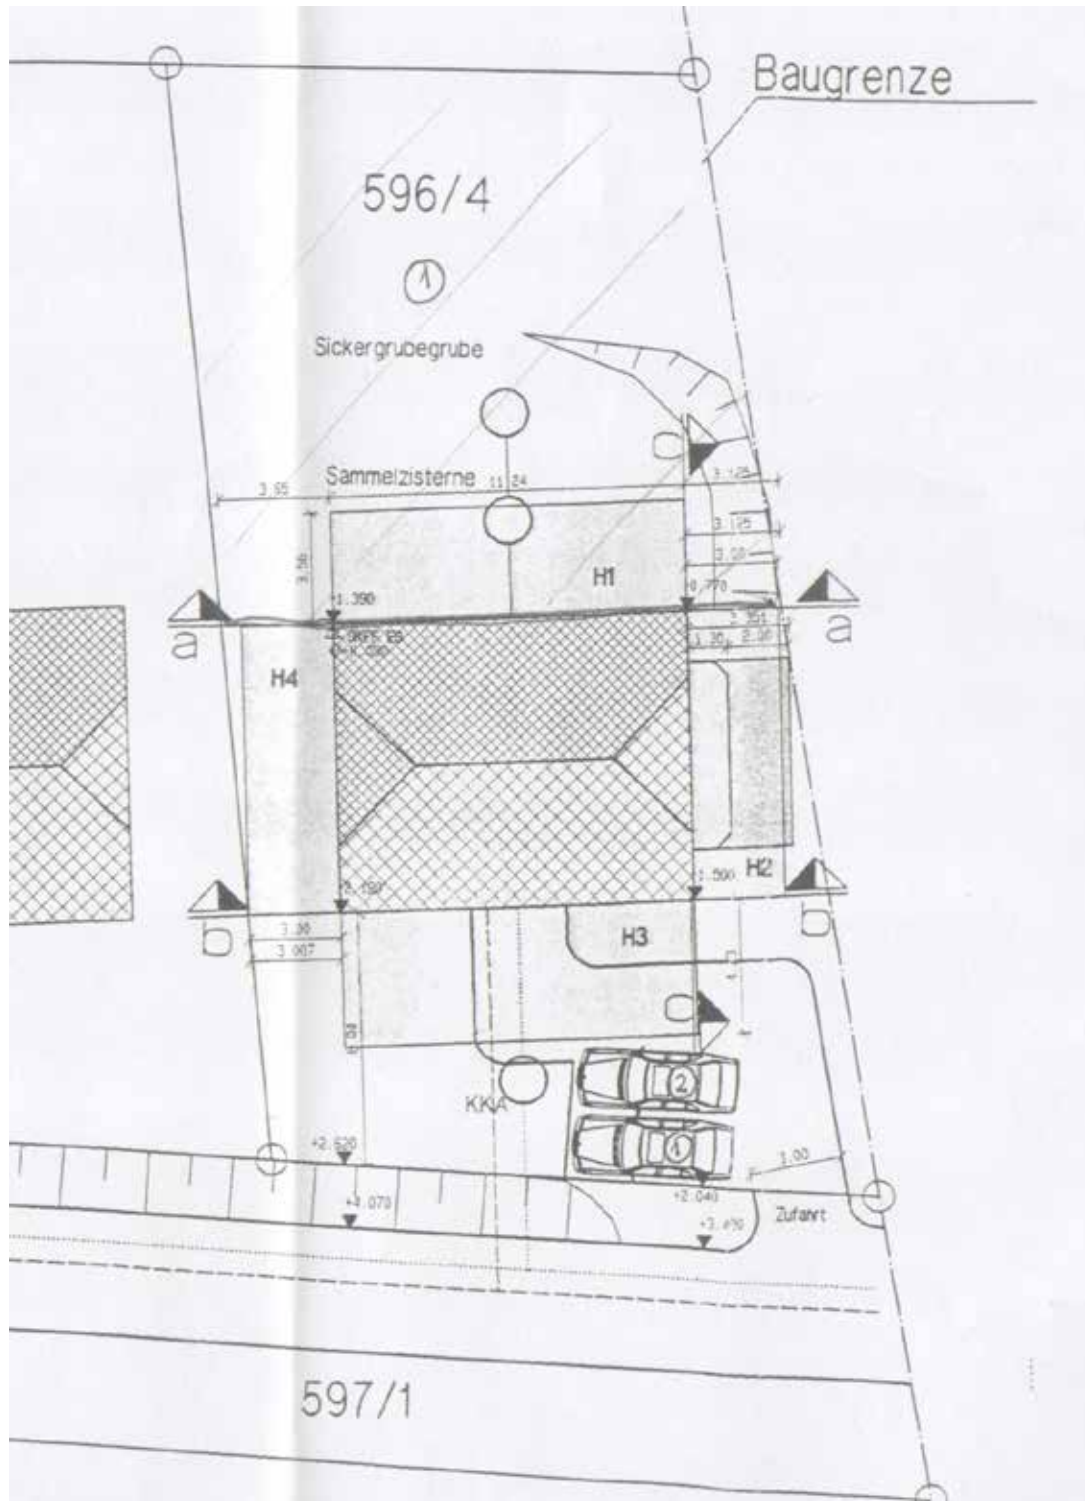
Lageplan (Status nicht aktuell: Garage und Anbau nicht dargestellt)
